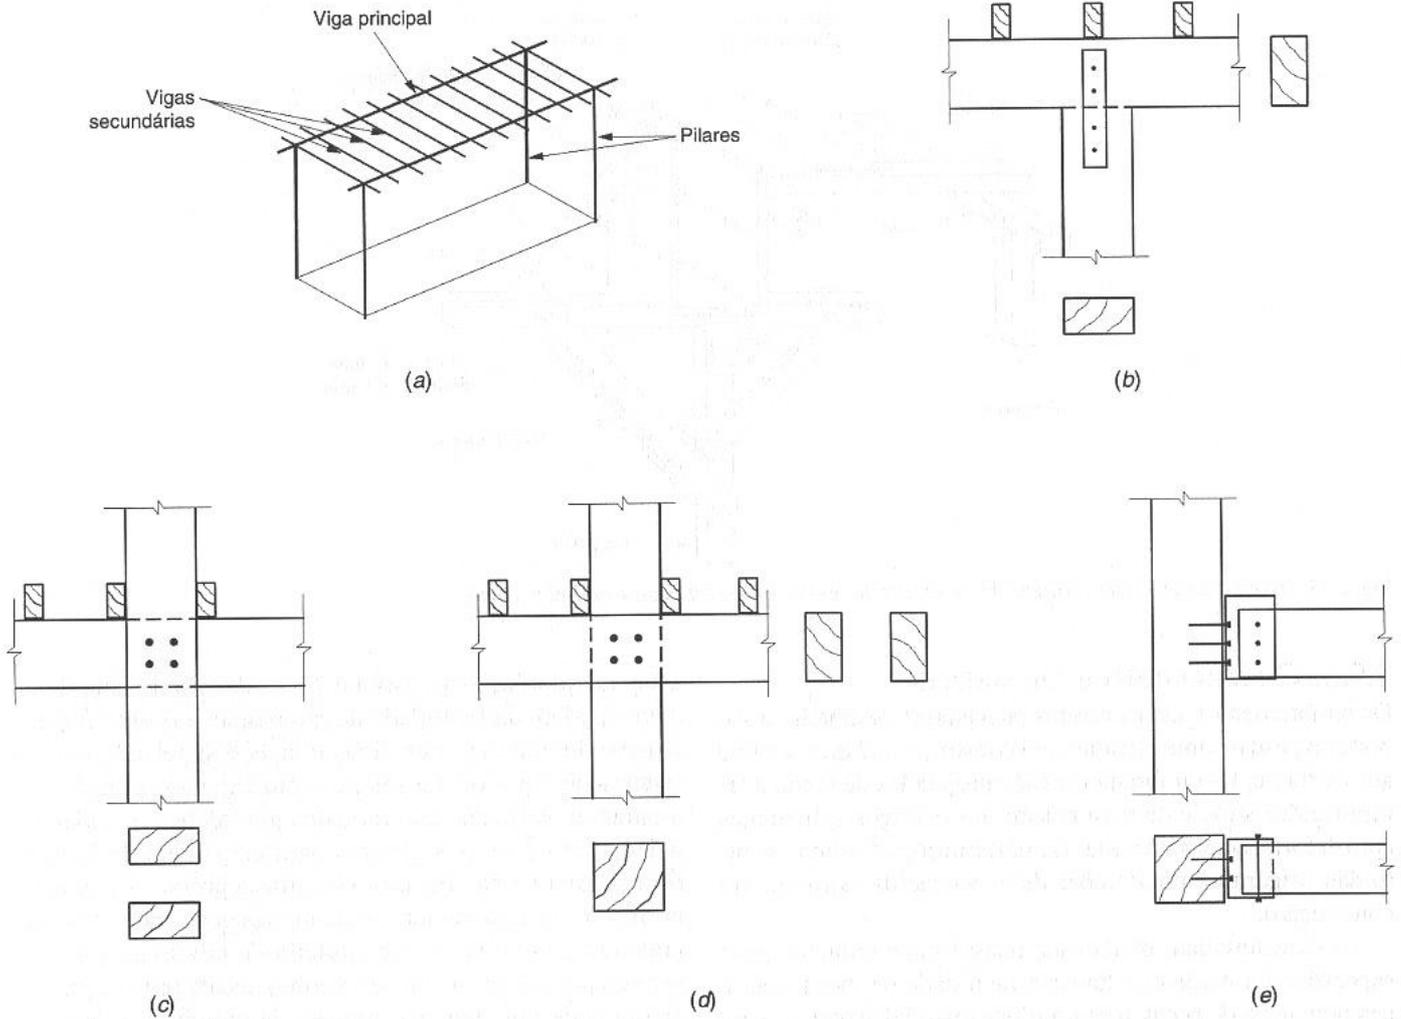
Sistema estrutural para edificações e tipos de ligação viga-pilar.
